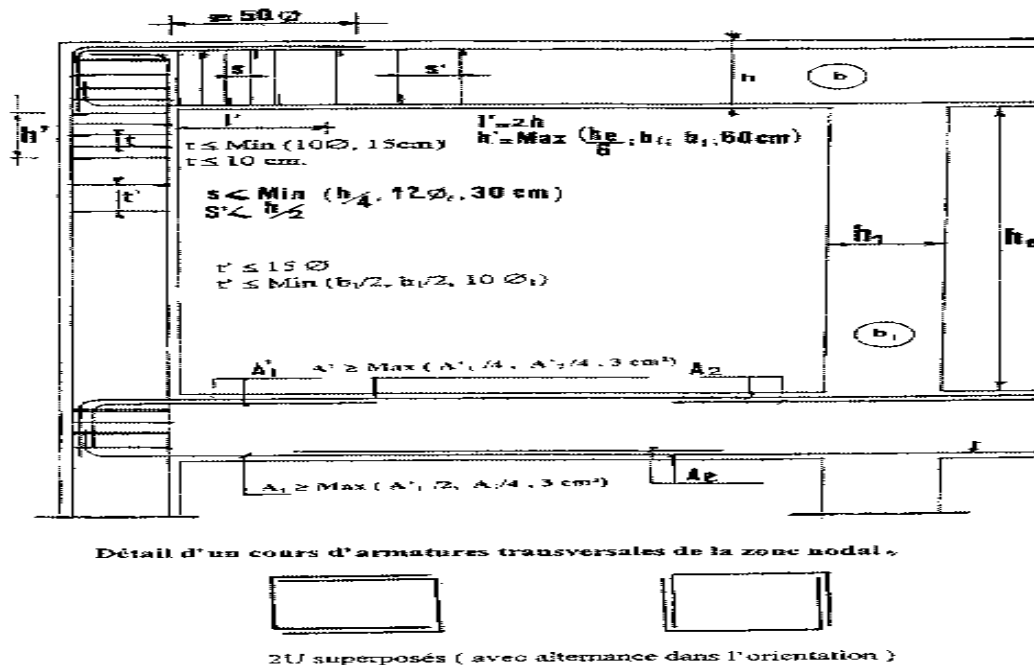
Disposition constructives pour les poutres selon R.P.A99/03
